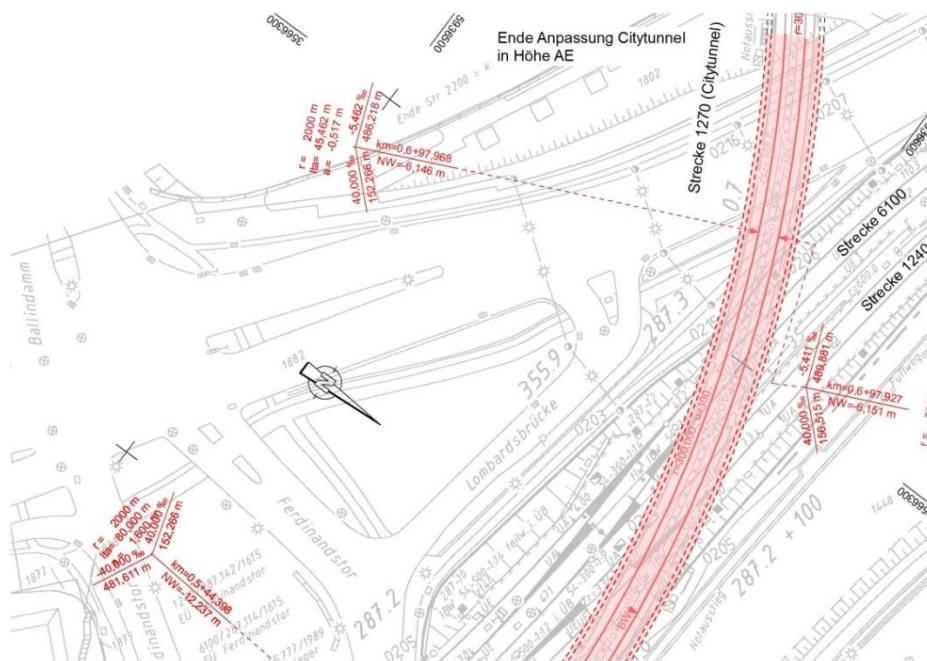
Lageplan Variante 4- Anpassung City-Tunnel
